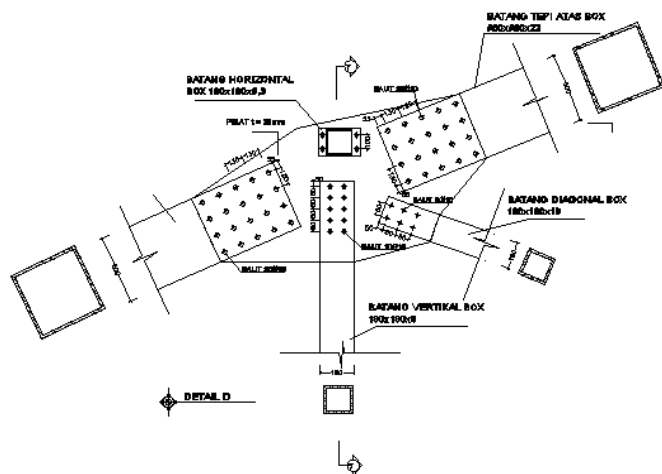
Denah Detail Sambungan Rangka Utama
